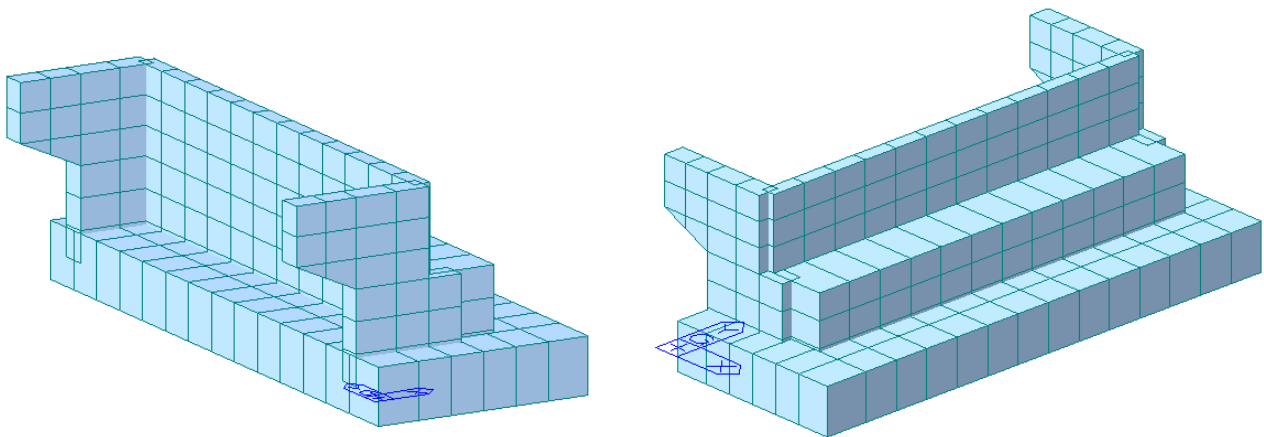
Viste 3d del modello di calcolo spalla fissa
